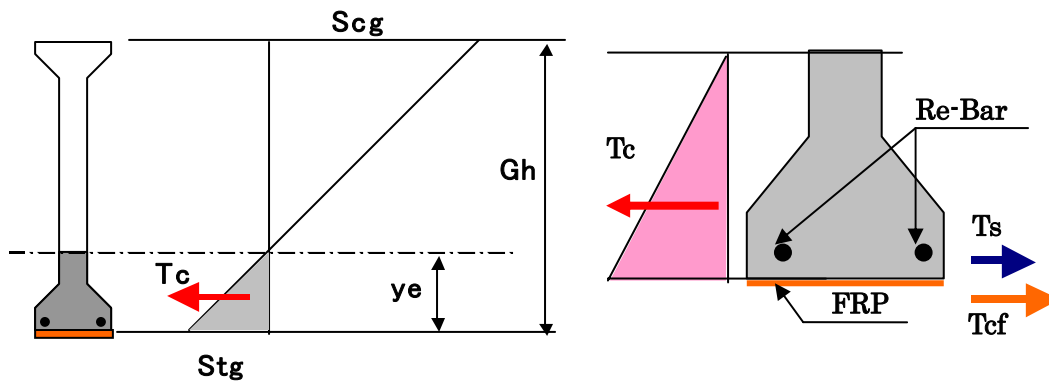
Imagen del Esfuerzo de Tensión de la viga tipo I prefabricada
